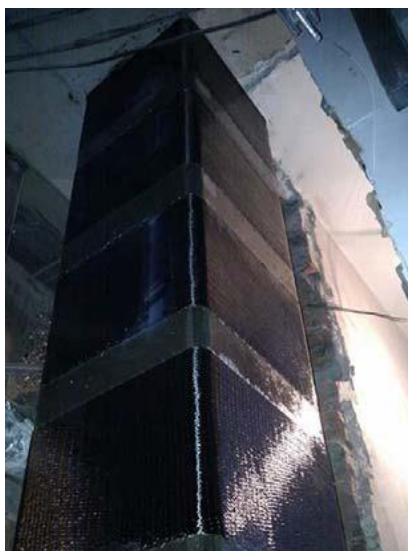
Внешне армированная углеродным волокном железобетонная колонна
